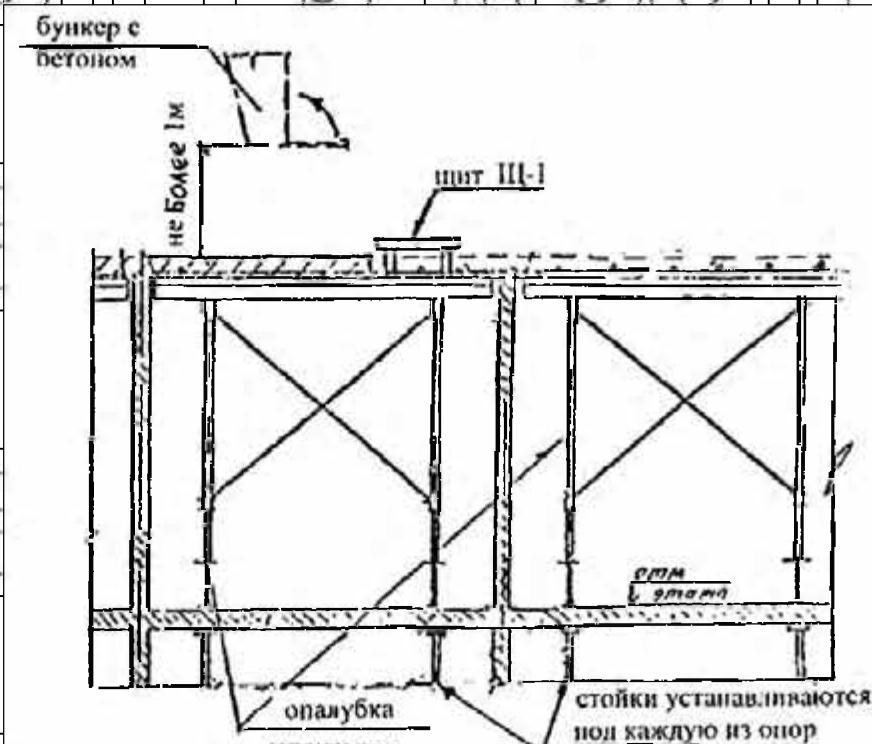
Вивання бетонотуженої суміші з бункера в опалубку перекривитя
